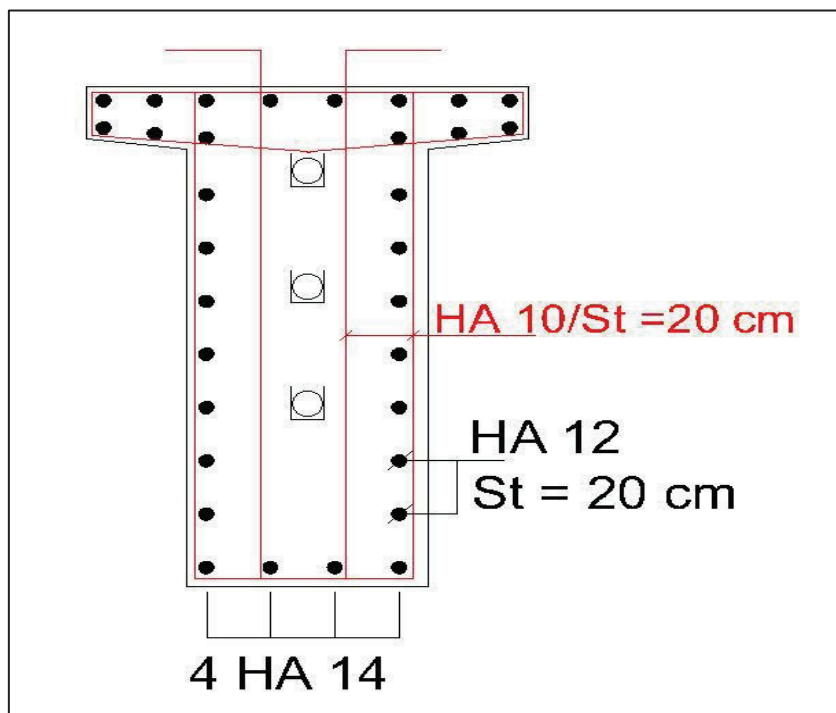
Croquis du ferrailage de la poutre en section d'about
